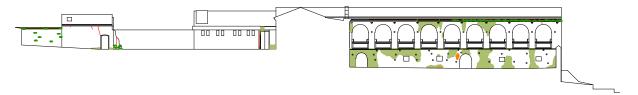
Relevamiento de lesiones - Fachada interna Sur I
